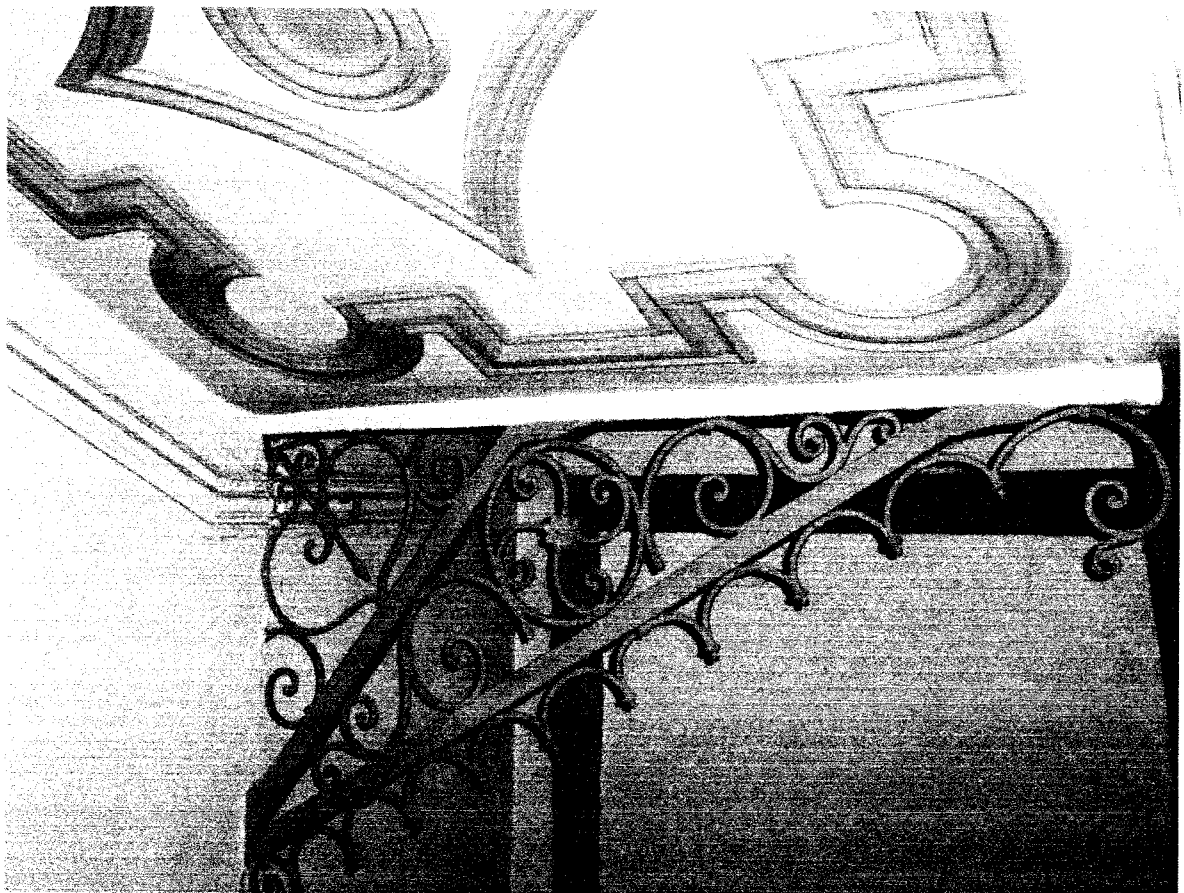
Первый этаж. Помещение 14. Кронштейн и филенки под лестничным маршем
